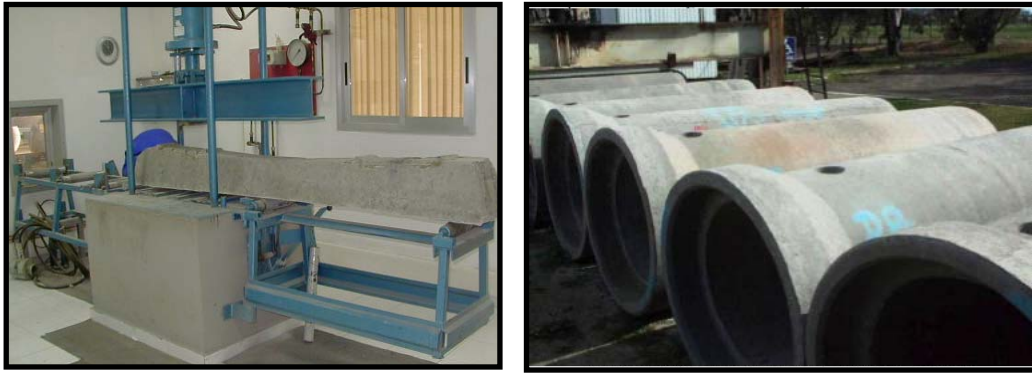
Hormigones de ceniza volante activadas alcalinamente (a) Traviesas de ferrocarril [61] (b) Tubos para la red de alcantarillado (1500 mm de diámetro) [58]
